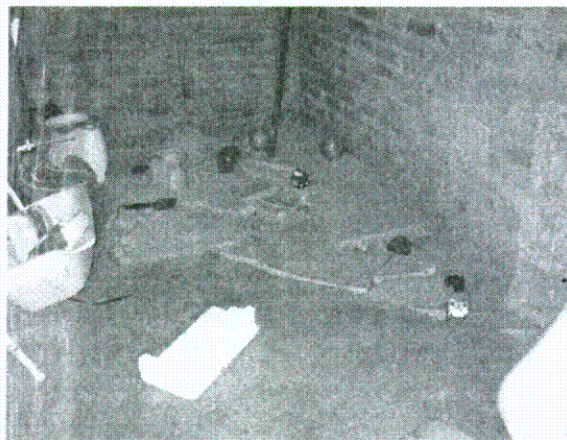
Hundimiento y grietas en la placa de piso de la zona de sótano.
